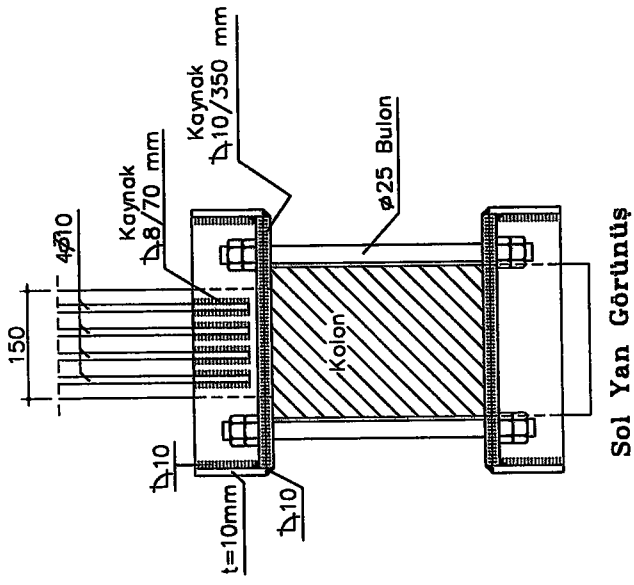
BM ve BE elemanlarının boyut ve donatı detayı
